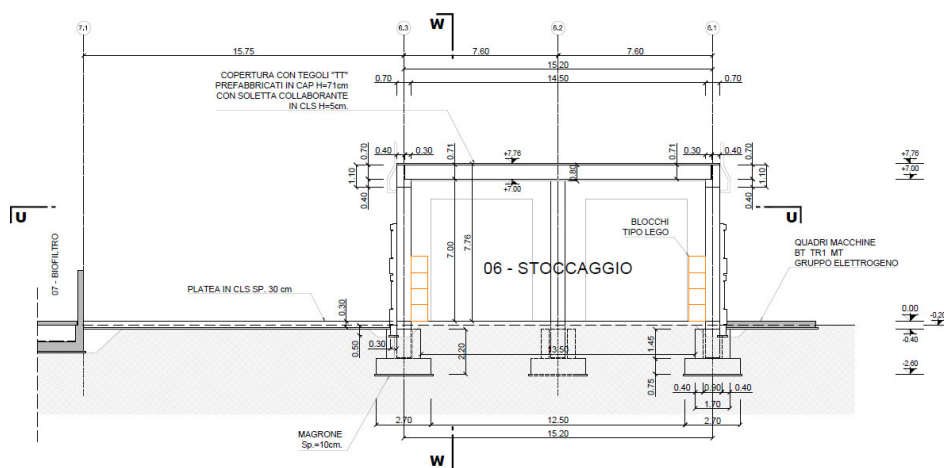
SEZIONE TRASVERSALE STOCCAGGIO
